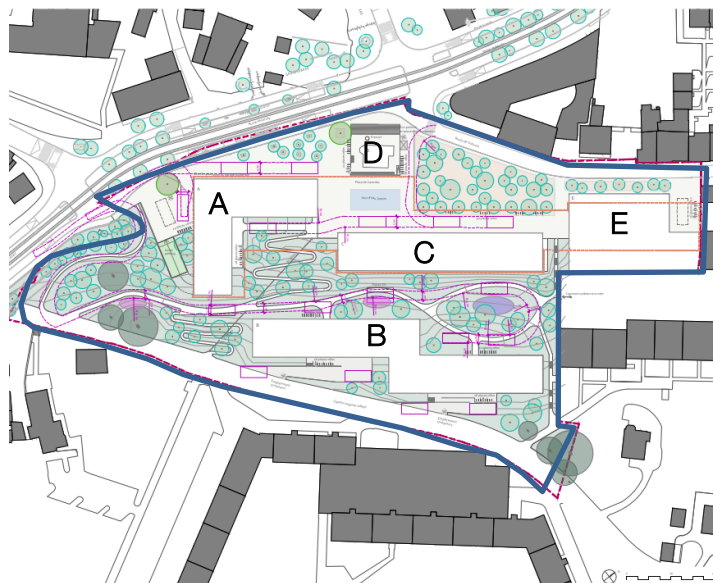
Plan masse (source : Hager, mars 2022) En bleu, le PLQ Carantec
